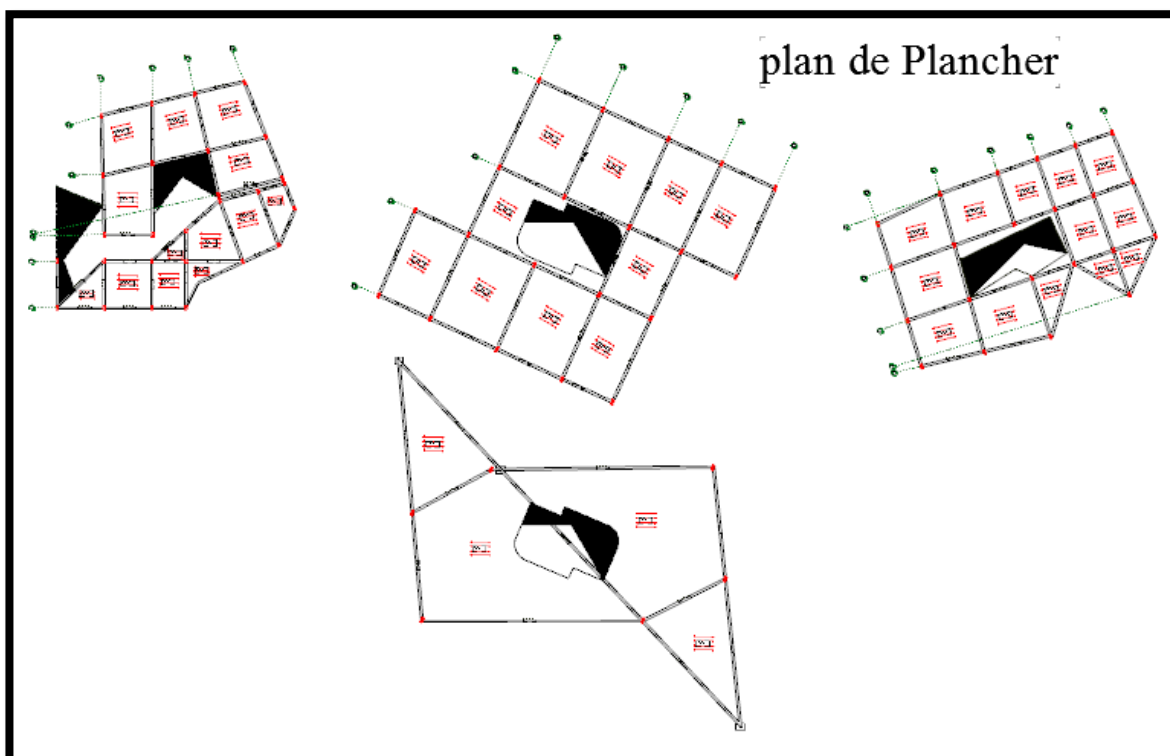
plan de plancher bloc 01 du musée Source : auteur
